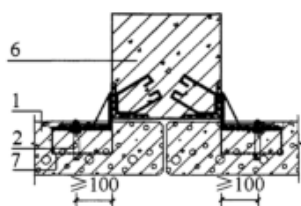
改性蒸压加气混凝土墙板采用预埋锚栓与主体结构连接构造示意图（一）
